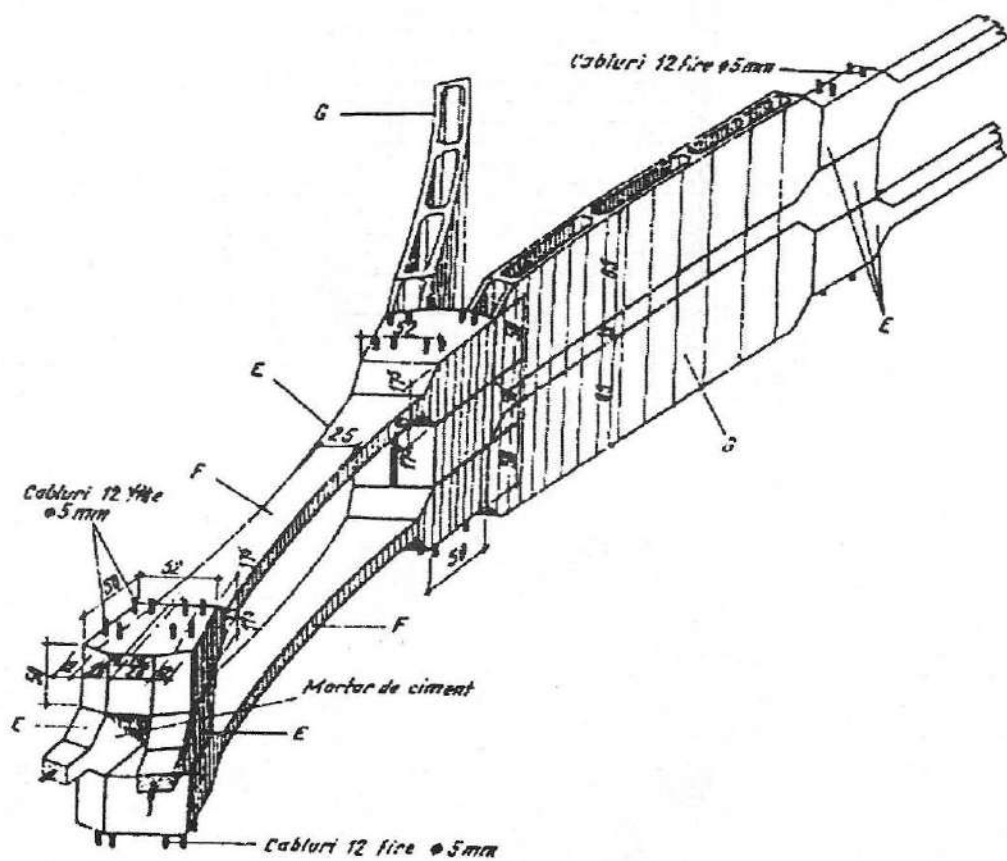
Elemente din beton armat pentru celule pretensionate.
